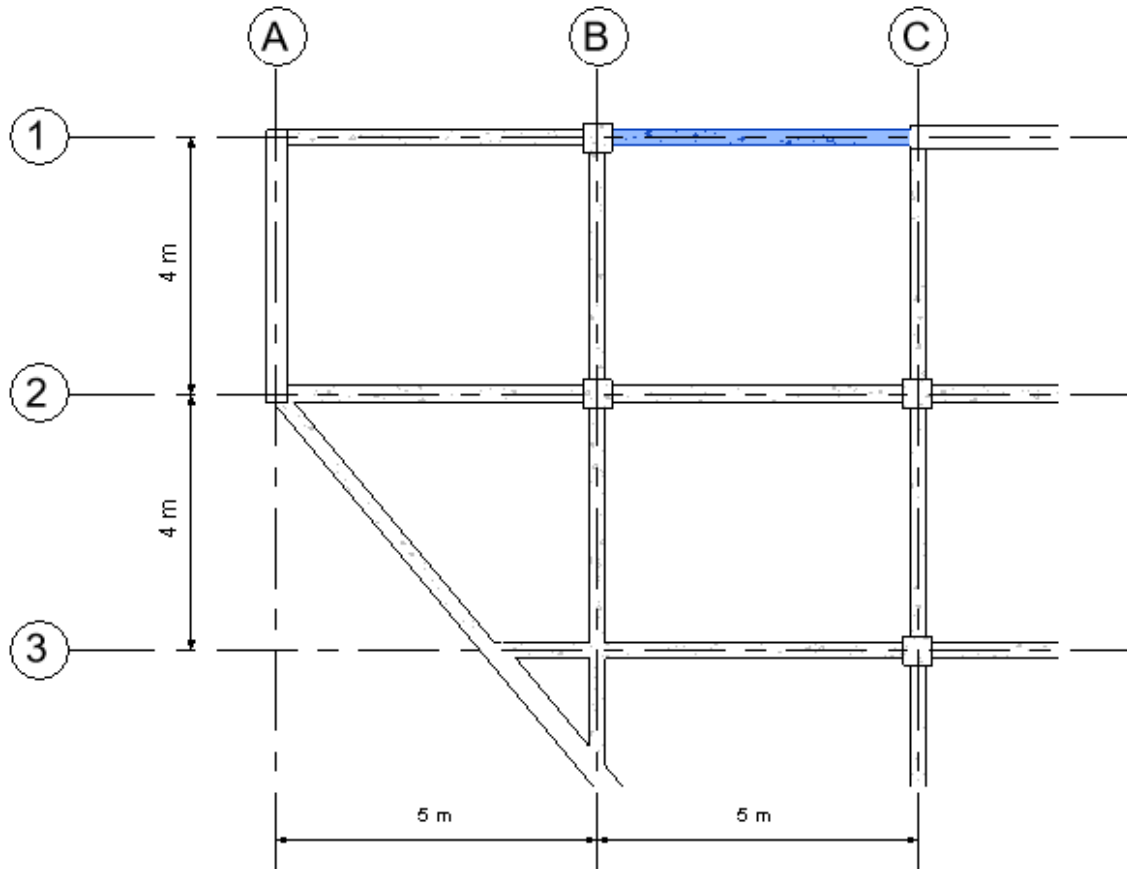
Viga de diseño. Fuente: elaboración propia.
